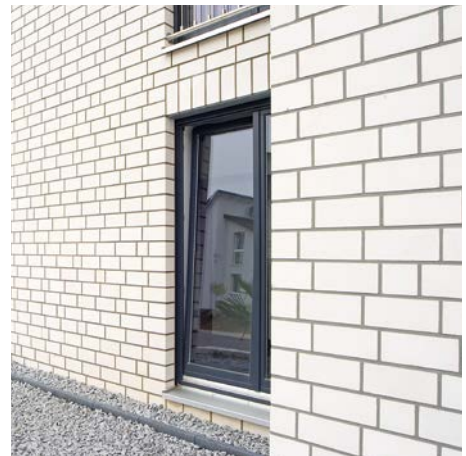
Sichtmauerwerk als gestalterisches Element der Fassade
